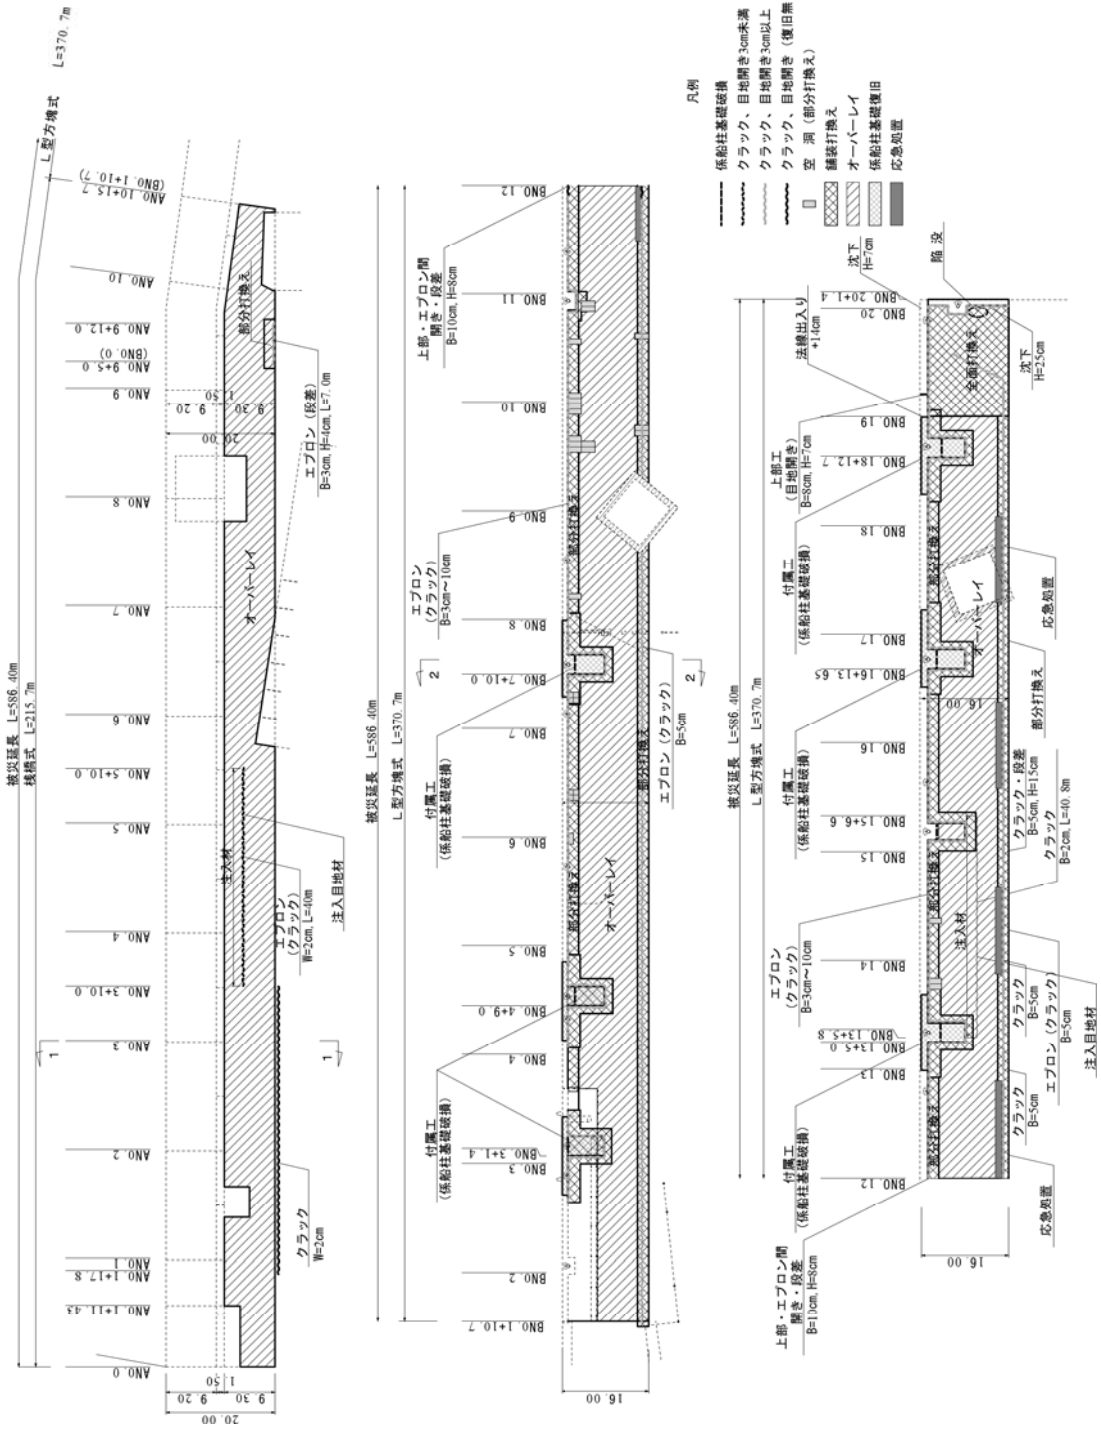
中央埠頭西側-10m 岸壁・栈橋の被災・復旧平面図
